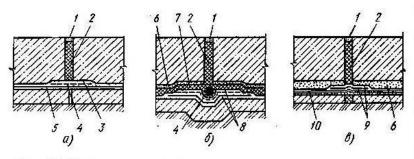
Гидроизоляция деформационных швов на фундаментных плитах или полуподвала (a-e):
